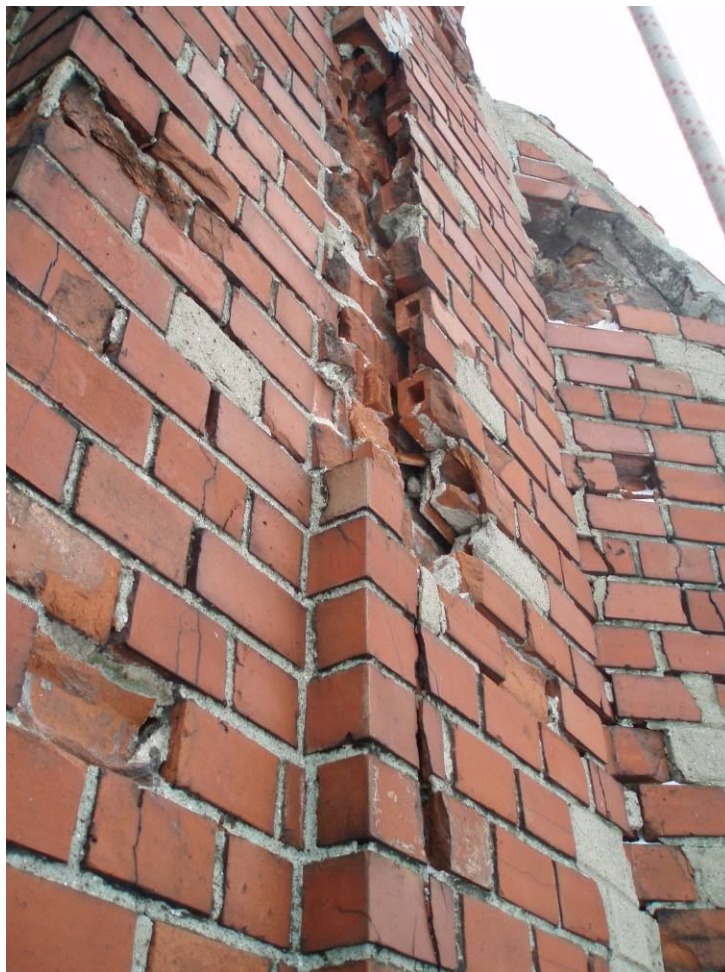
Odspojone i pęknięte cegły elewacyjne oraz cegła przewiązująca warstwę elewacyjną z warstwą nośną. Widoczne powierzchowne zabezpieczenie zaprawą na bazie cementu.
